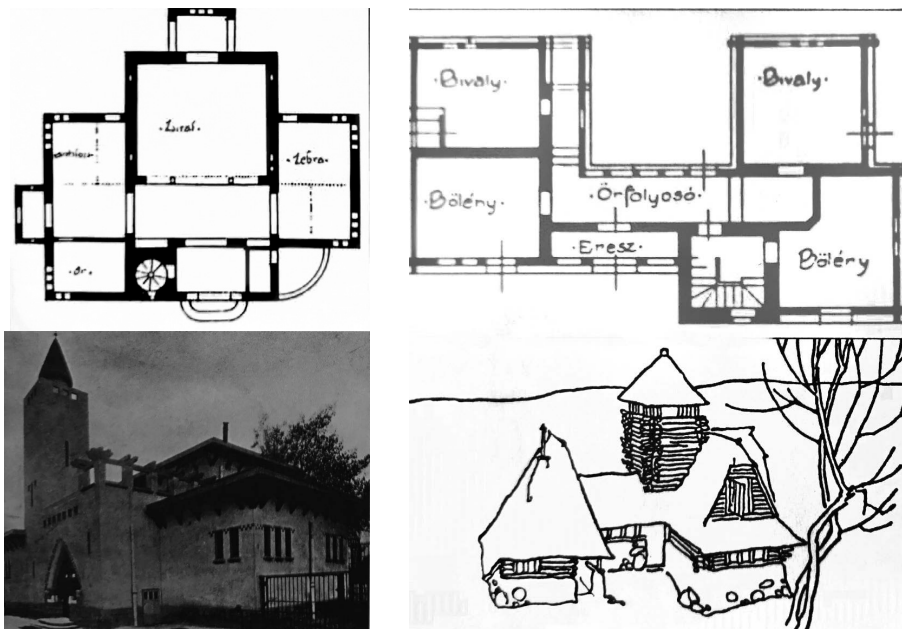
Pavilhão das Girafas e Pavilhão dos Bisontes
